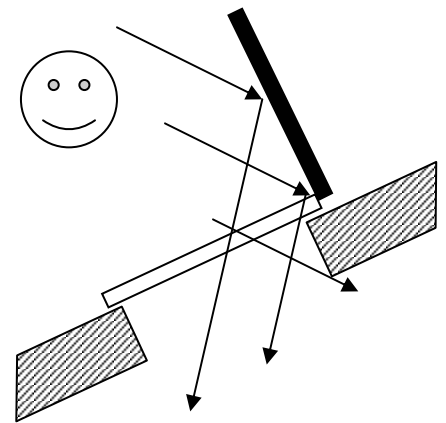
Clarabóia em plano inclinado com sistema reflector
